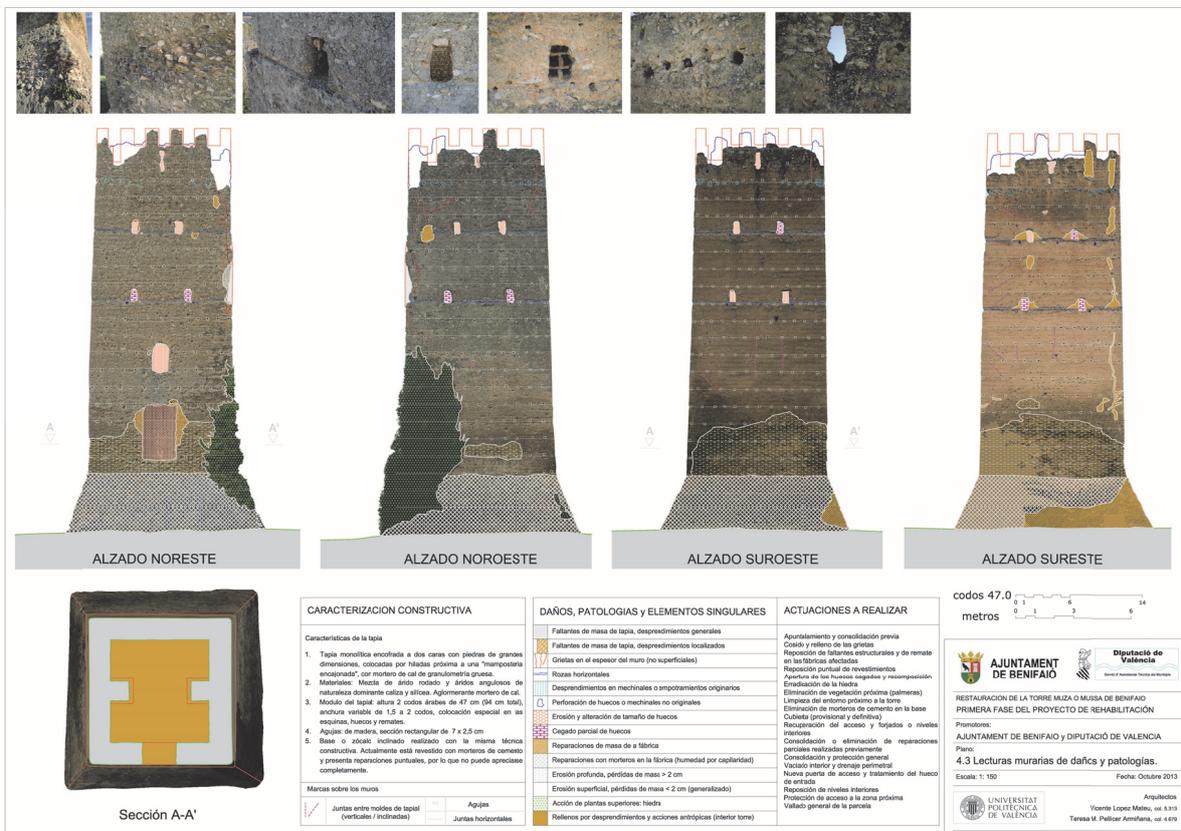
Planos de lectura constructiva y muraria de la parte exterior de la torre.
